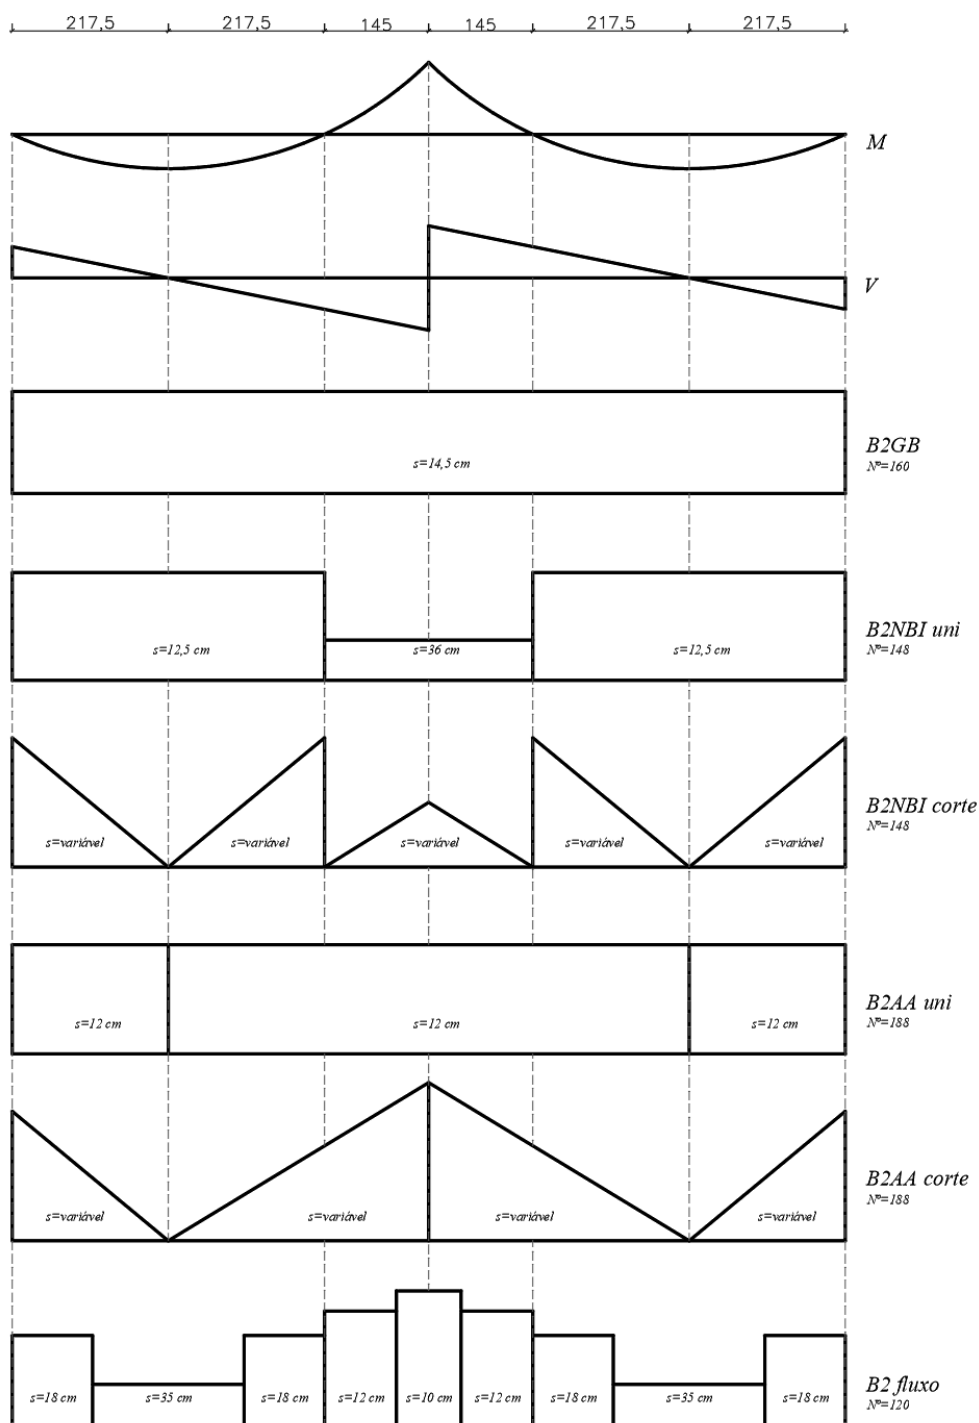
Configurações adotadas para as vigas contínuas (tipo B2)
